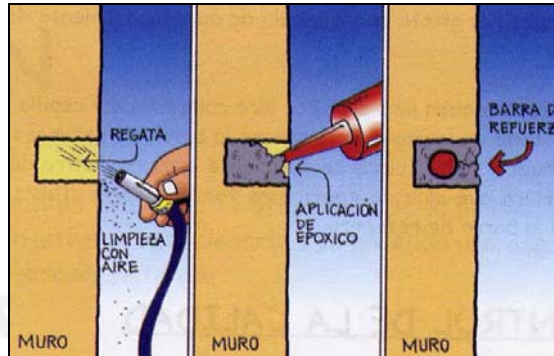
Reforzamiento del muro (AIS 2002)
